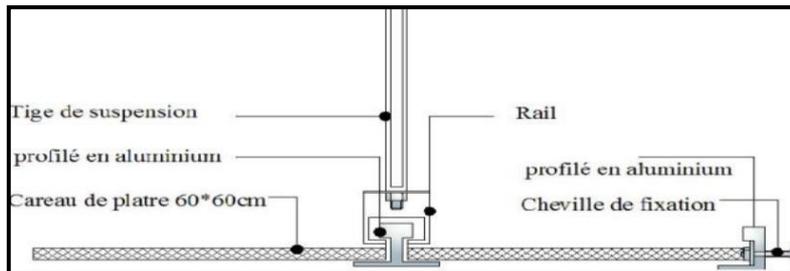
Fixation du faux Plafond ;source :archdaily.com
